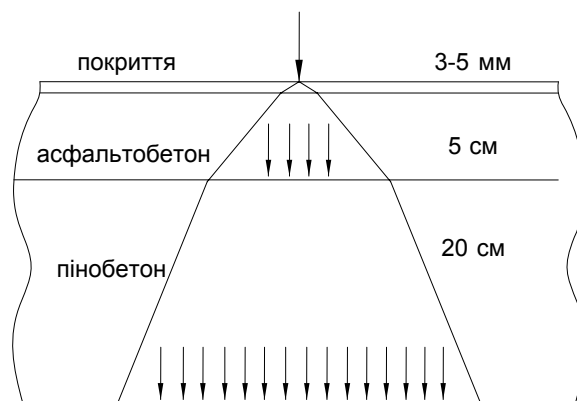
Розподіл навантаження від колеса на ґрунти через пінобетонну основу
